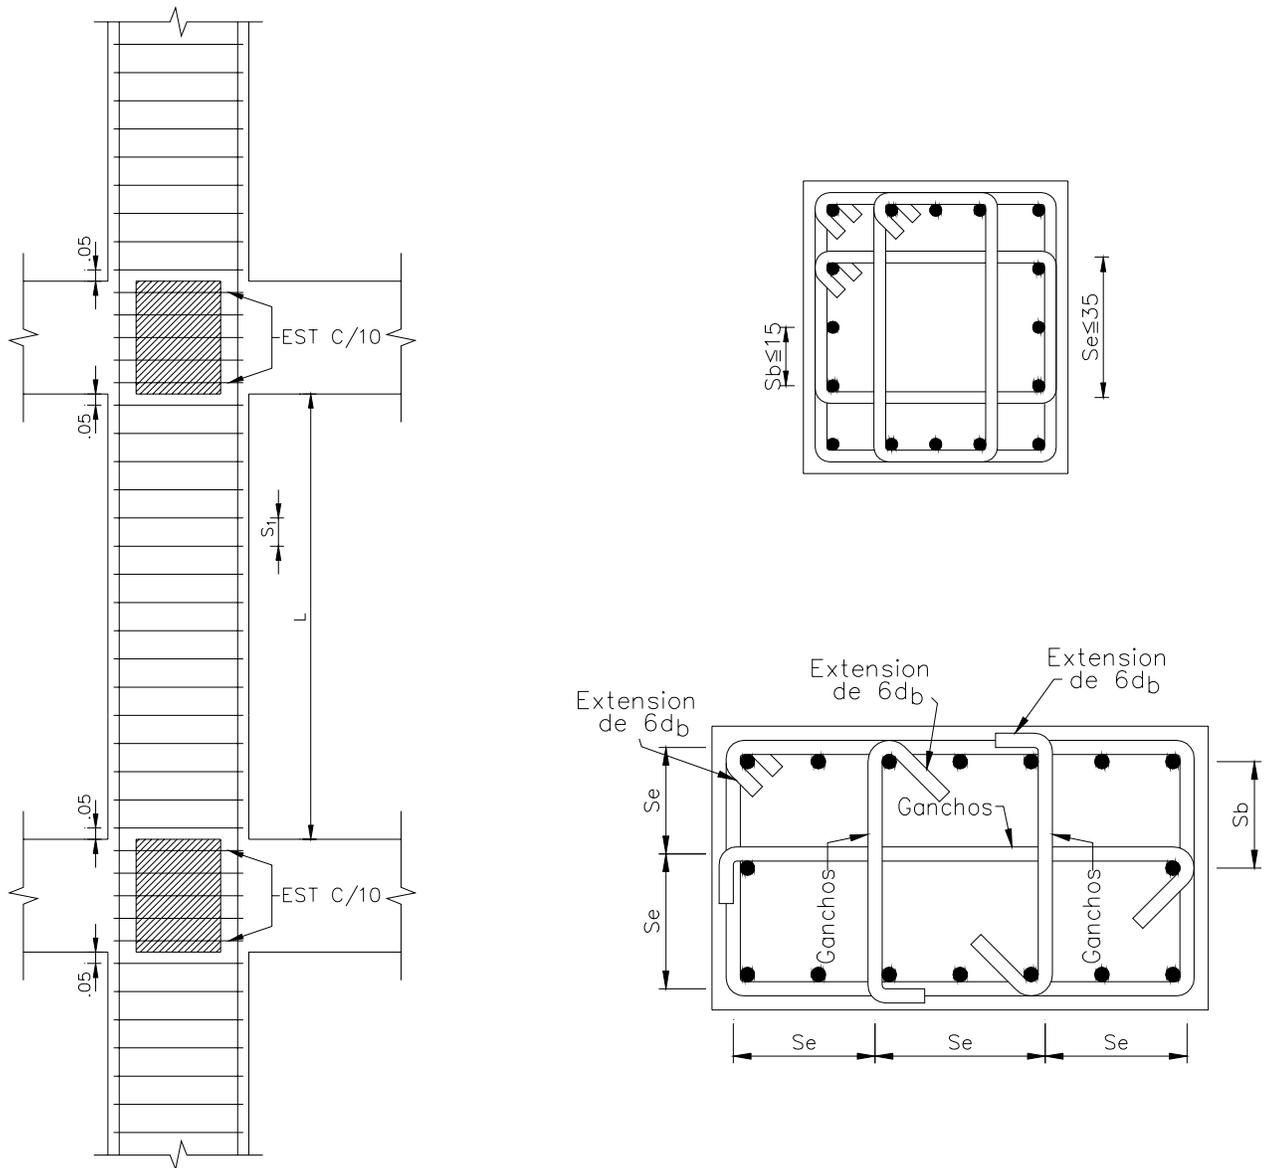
Requisitos para estribos y ganchos en columnas.
